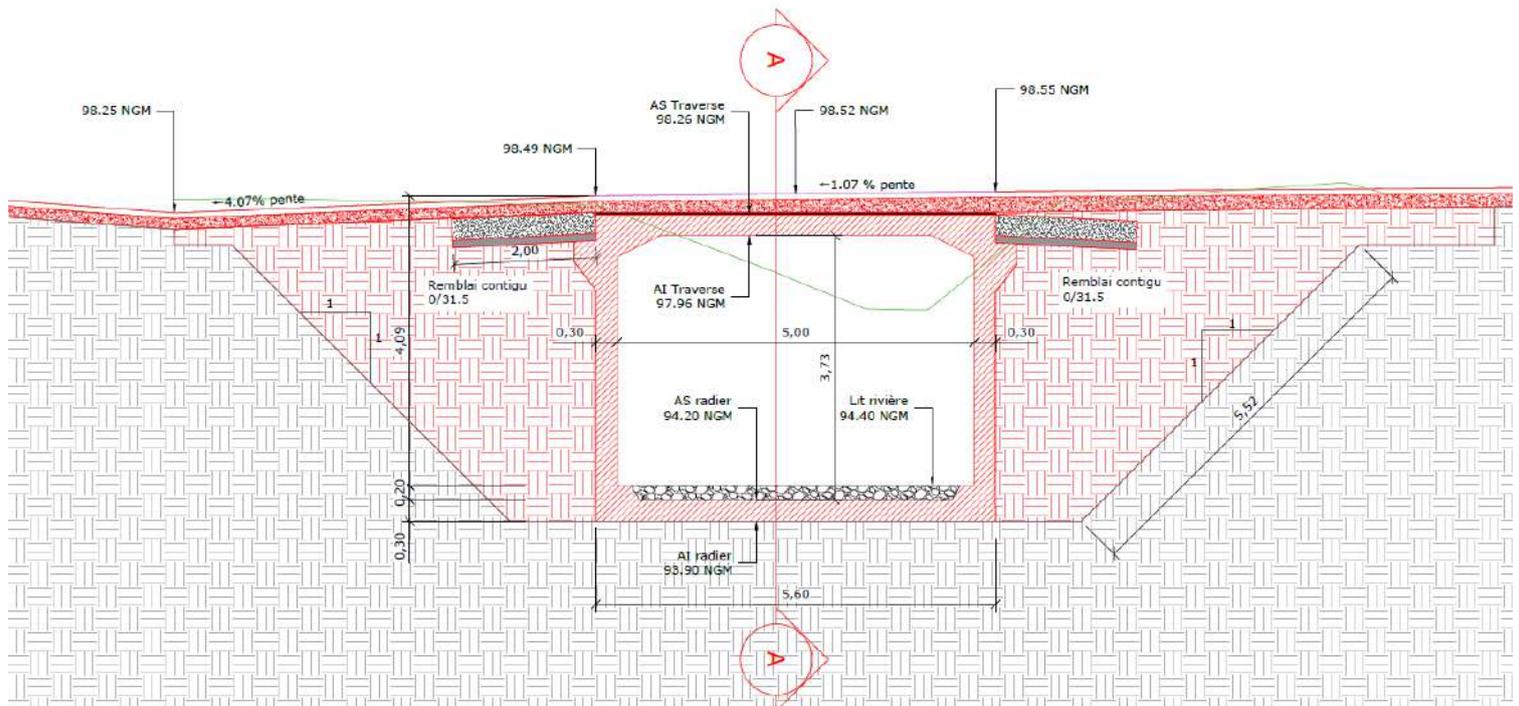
Coupe longitudinale sur l'ouvrage définitif
